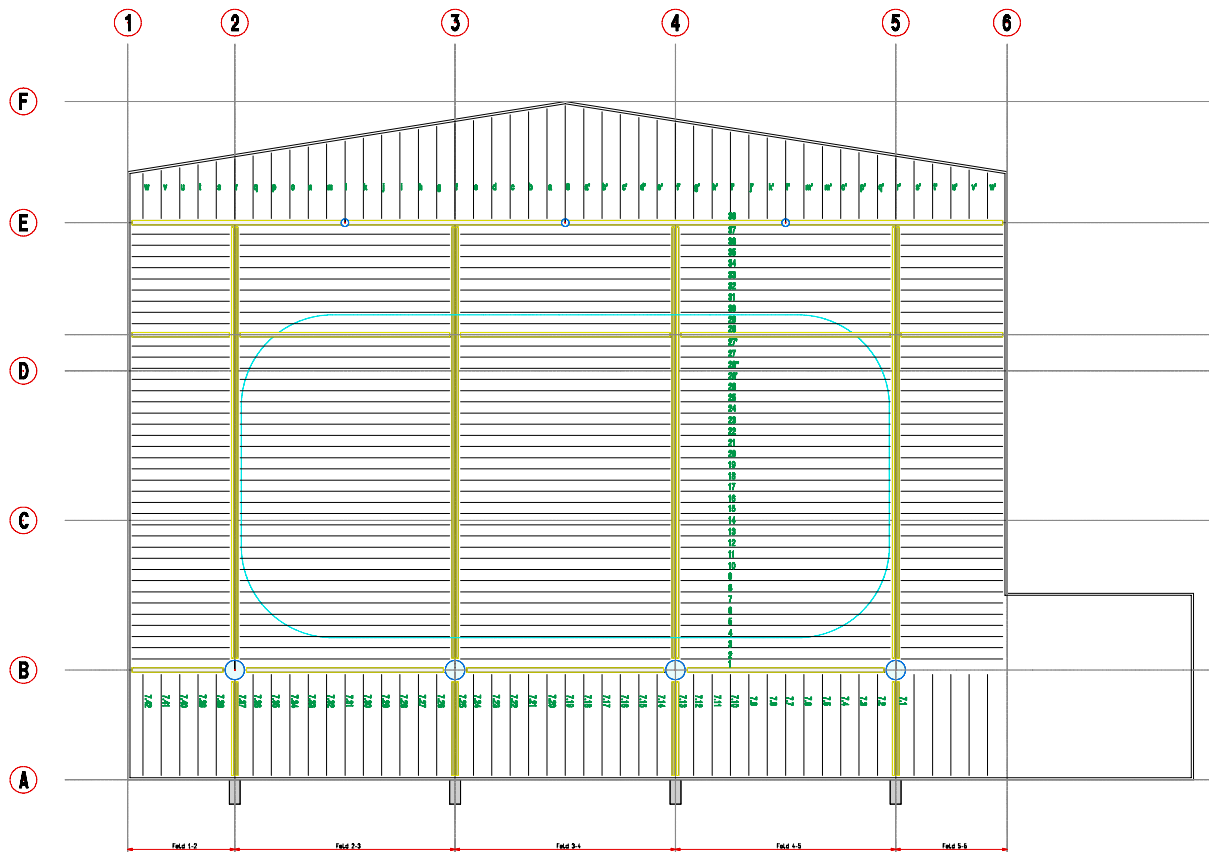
Grundriss, Beispiel der Durchnummerierung
